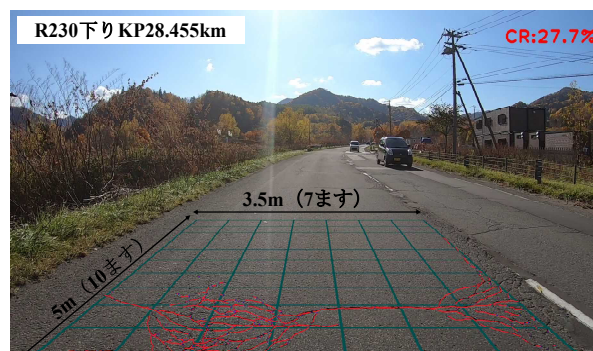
U-netを用いたピクセルレベルのひび割れ検出
